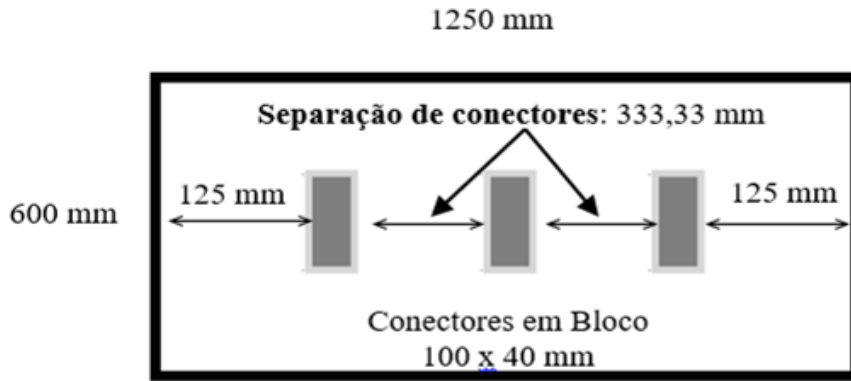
Distribuição em planta de conectores rígidos do painel sanduíche.
